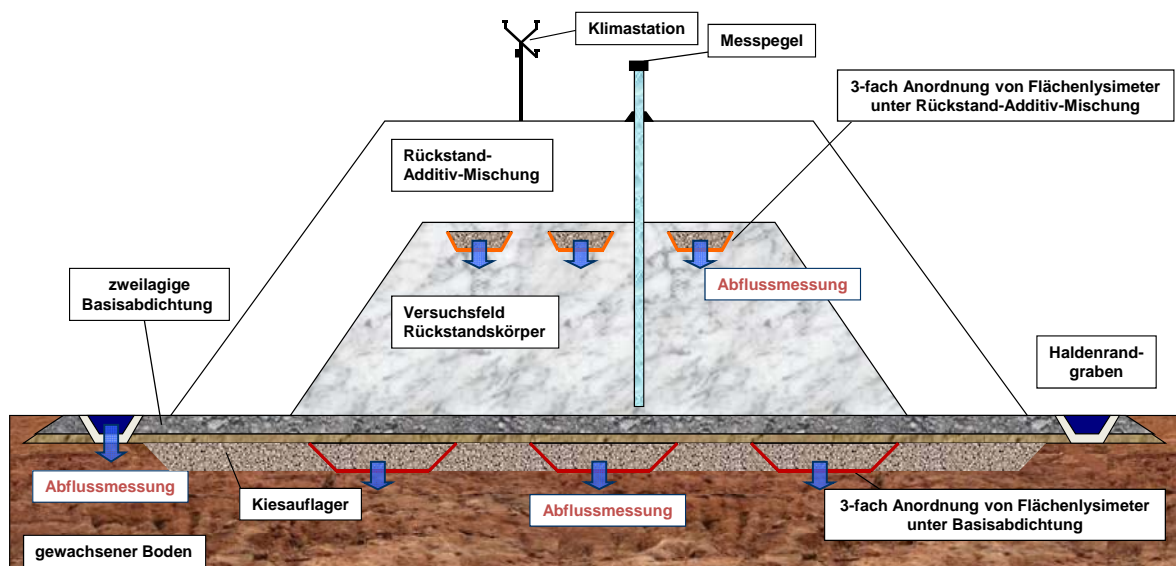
Pilothalde mit Messeinrichtungen, Schnitt in y-Richtung (Schnitt B-B)
